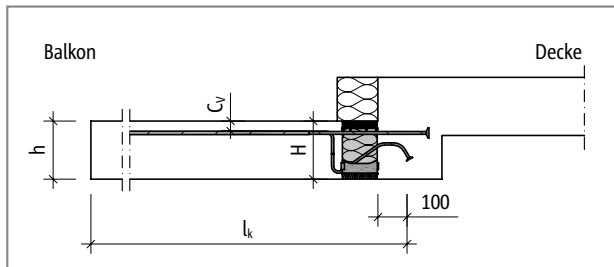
Schöck Isokorb® XT Typ KL-U: Statisches System
